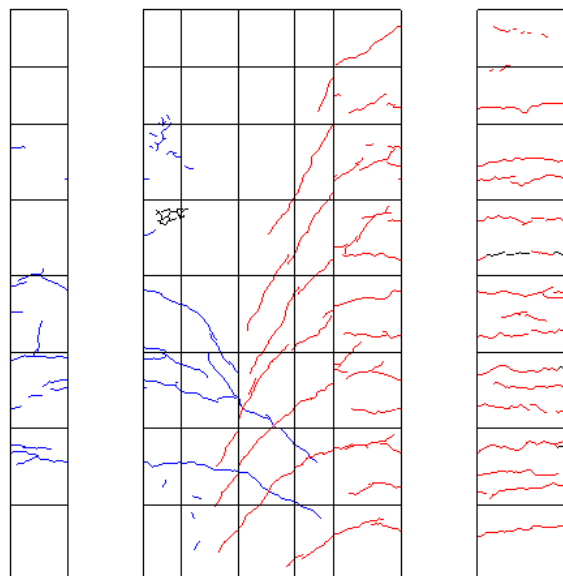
R=-1/200 ひび割れ図
